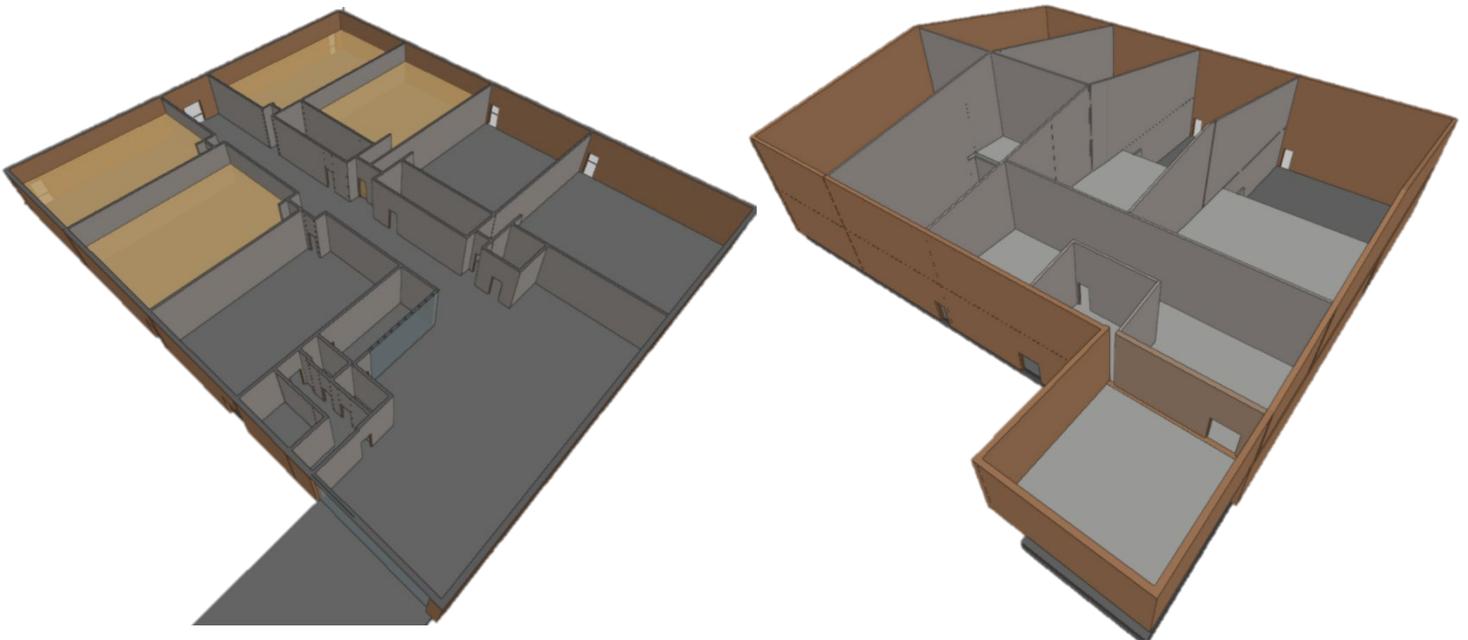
Previsualización 3D de planta baja y planta primera con la geometría simplificada.
